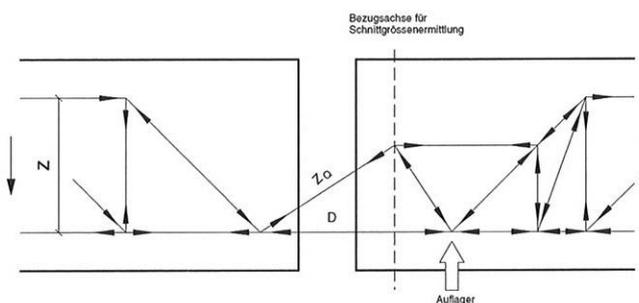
Egcobox Plattenelement Fachwerkmodell Typ PV-F; PV-D-F; PV-DD-F
